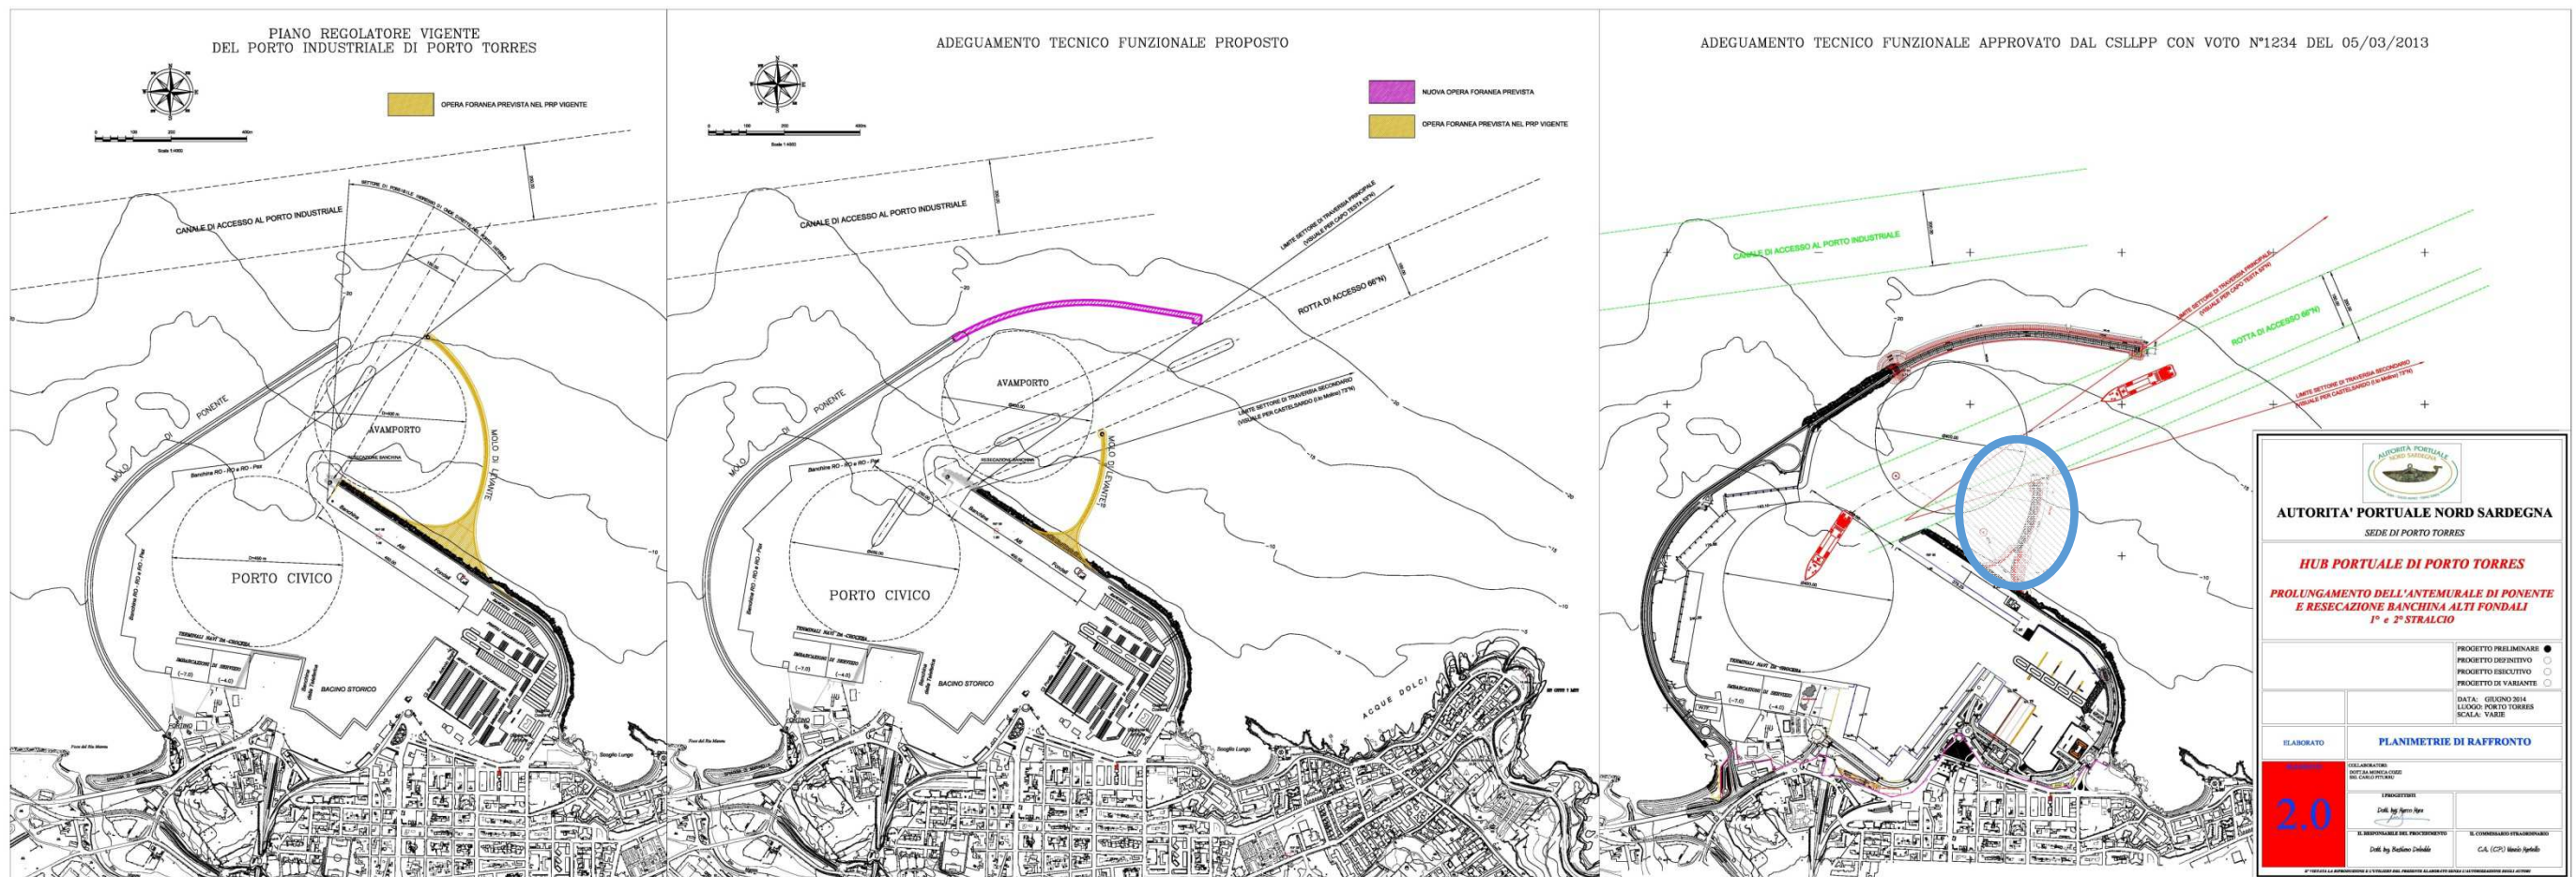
confronto planimetrico PRP, ATF proposto, ATF approvato (cerchiata in blu l'opera non compresa nel presente progetto)
